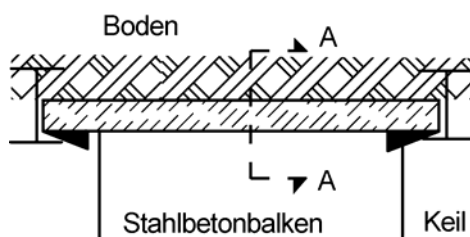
Ausfachung mit Stahlbetonfertigteilen [5]
